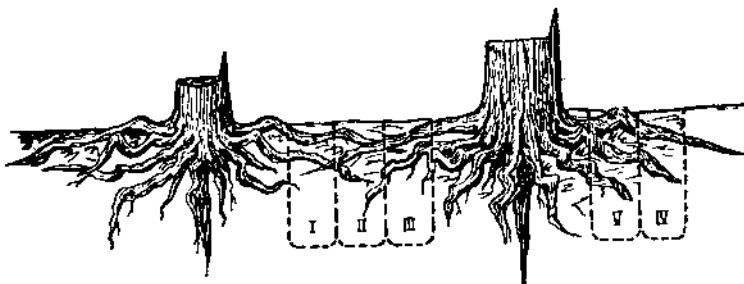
Работа фрезерного экскаватора среди пней и корней
